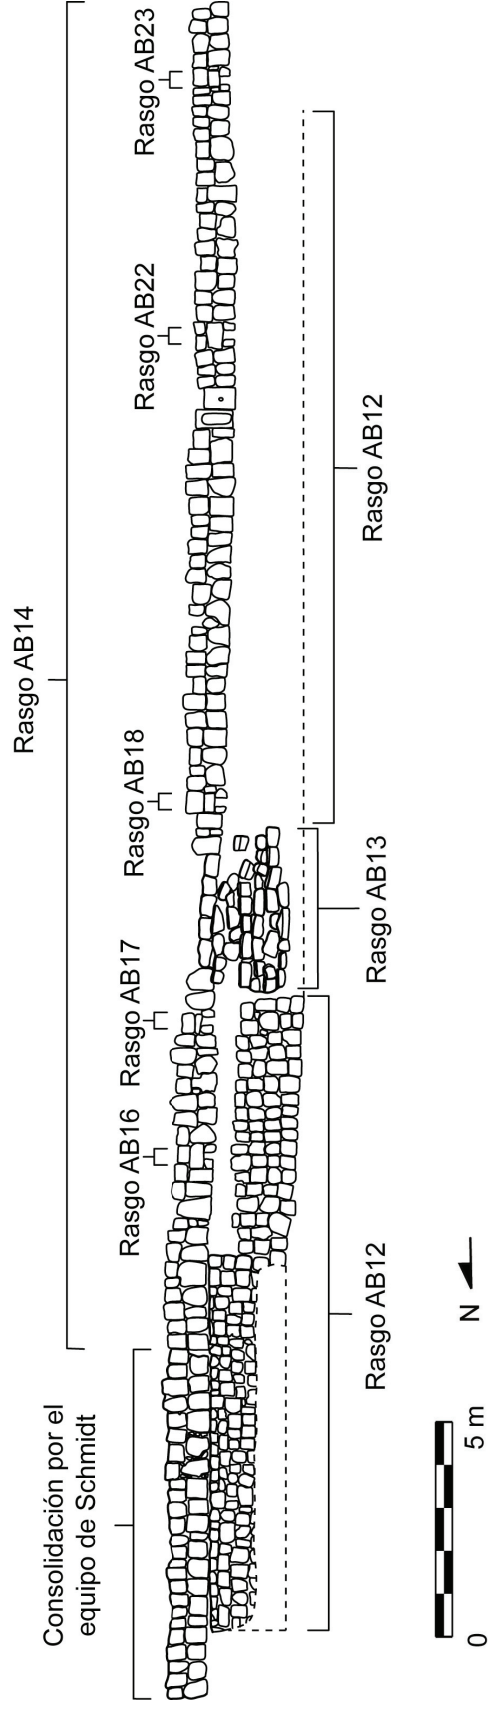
Alzado de la Muralla Sur, lado oeste.
